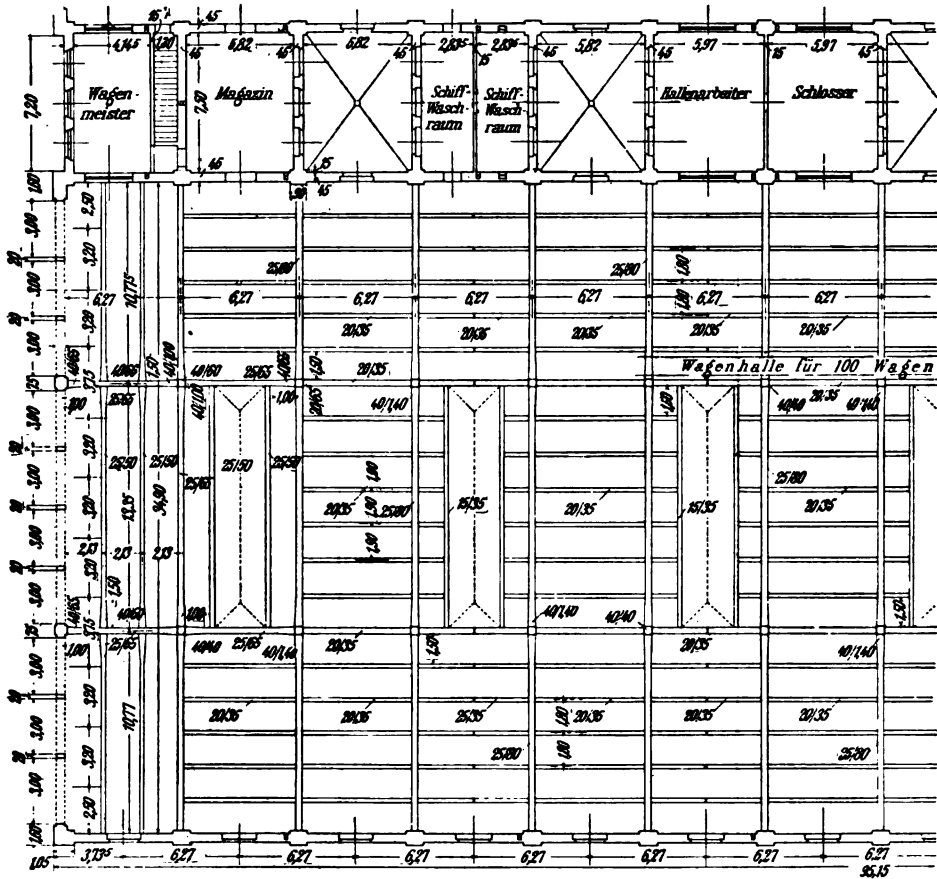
Grundriß der Wagenhalle auf Bahnhof Brigittenau, Wien.
